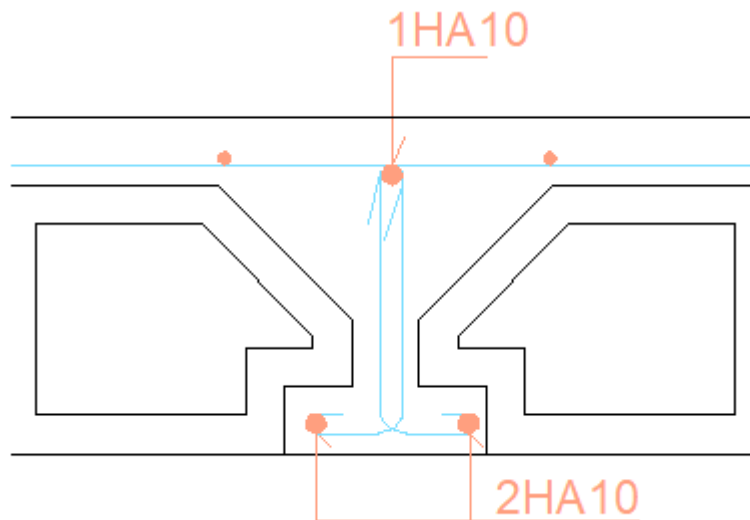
Schéma de ferrailage des nervures plancher étage.
